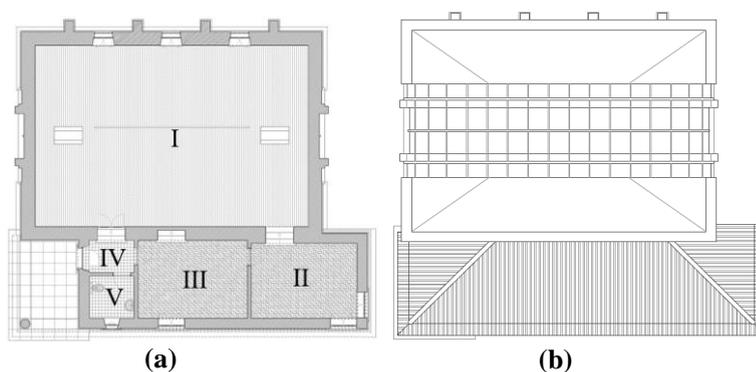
Planta interior (a) e planta de cobertura (b)
